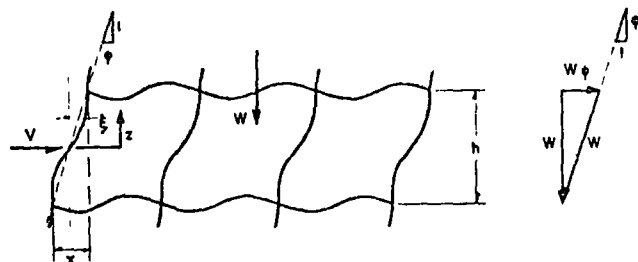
Entrepiso deformado sólo por flexión de los miembros estructurales
